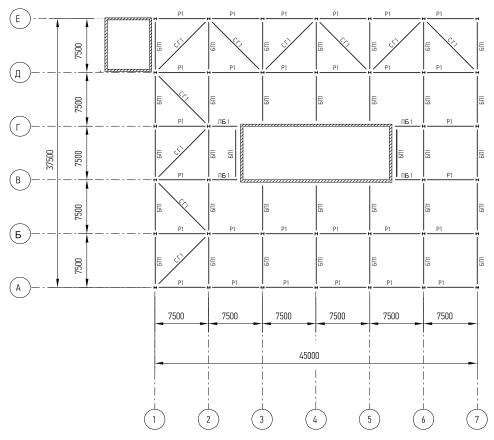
Маркировочный план несущих конструкций кровли для короткопролетной схемы стального каркаса (уровень 19)
